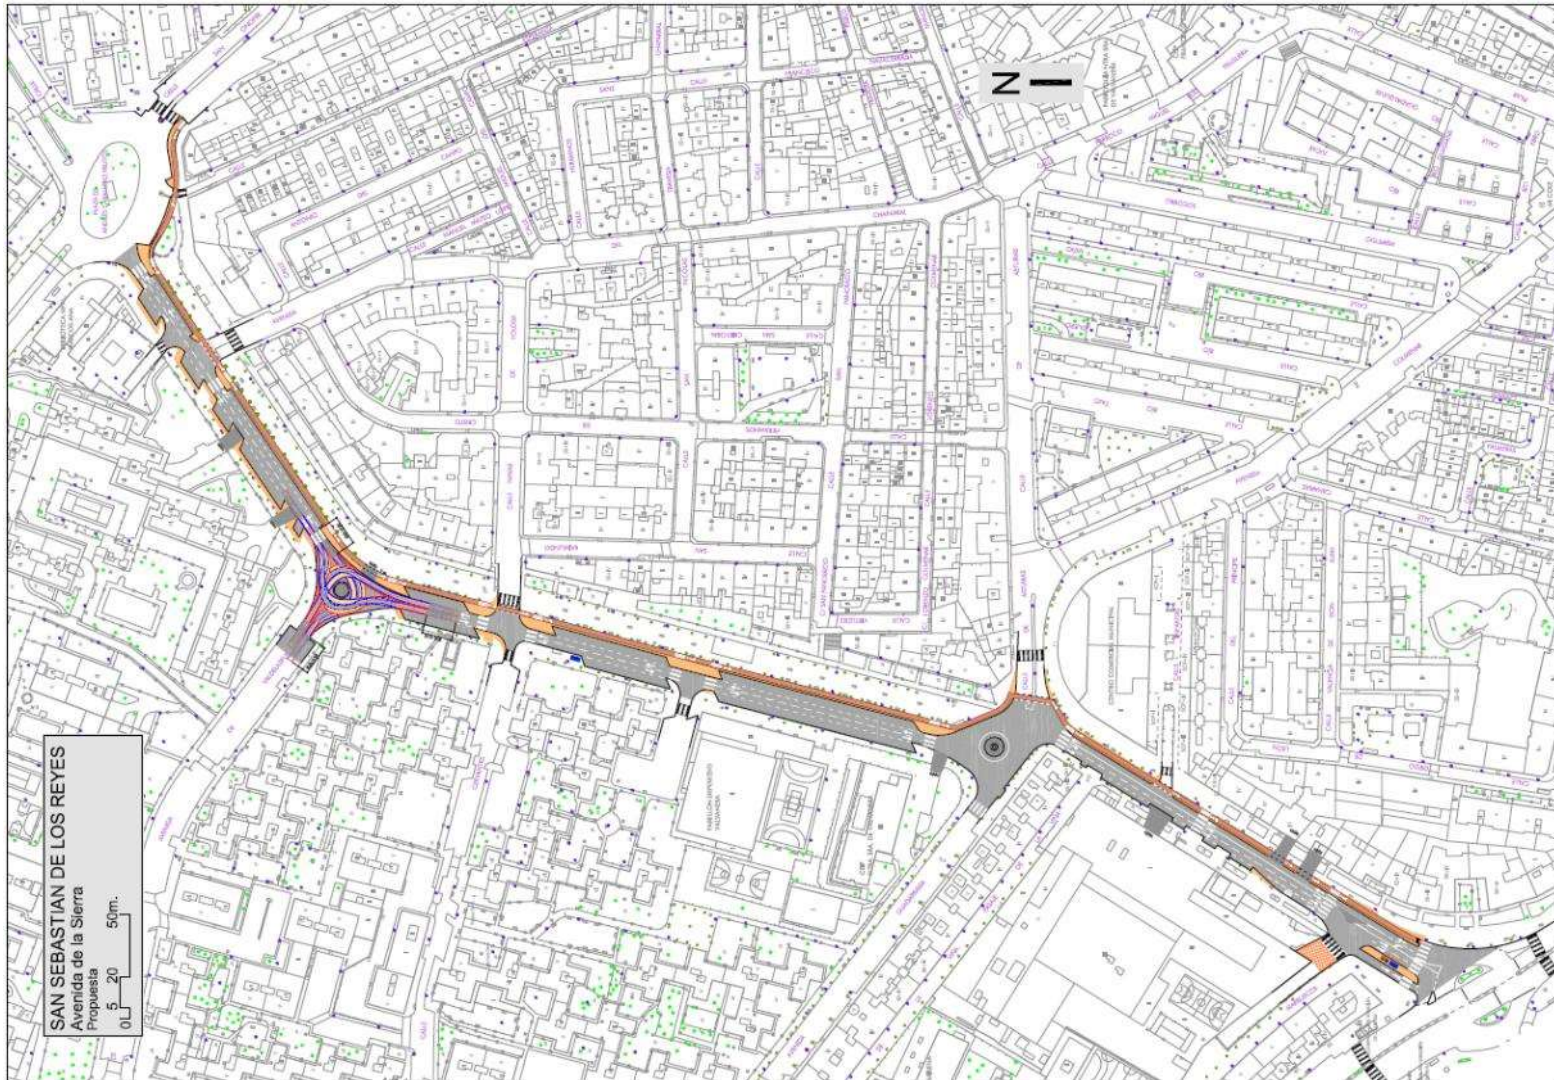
Planta Propuesta para Avenida de la Sierra. Fuente: DOYMO
